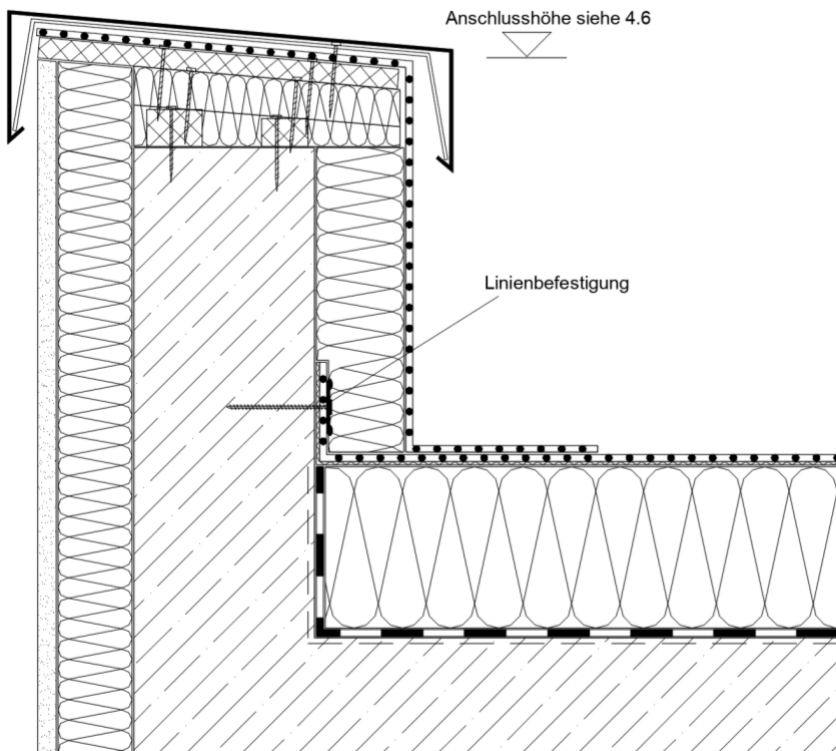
Starrer Dachrandabschluss – Ausführung mit Flüssigkunststoff (Ausführung der Dampfsperre als Behelfsabdichtung)
